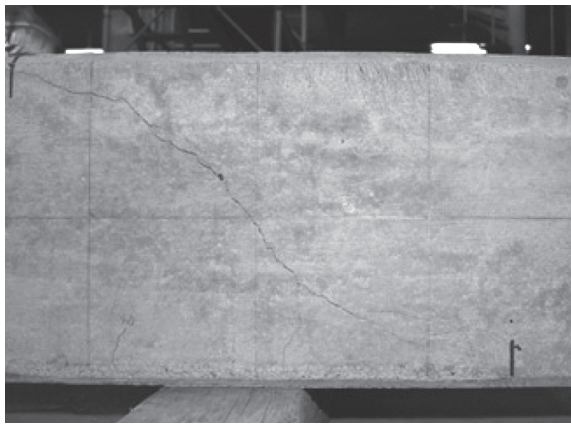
斜めひび割れ状況 (No.1)
